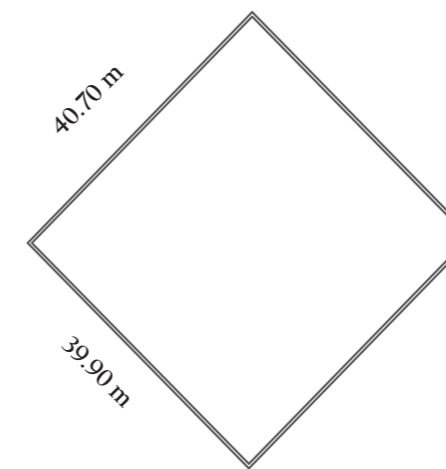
Dimensiones del terreno en donde se implanta el edificio COFIEC.
